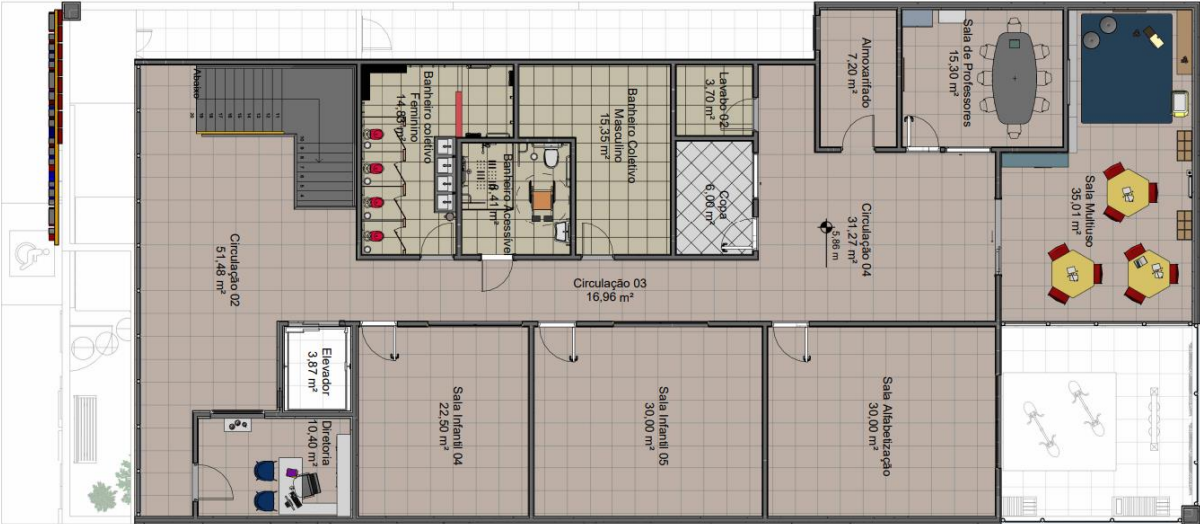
Planta Baixa do Piso Superior (Autoria Própria)
